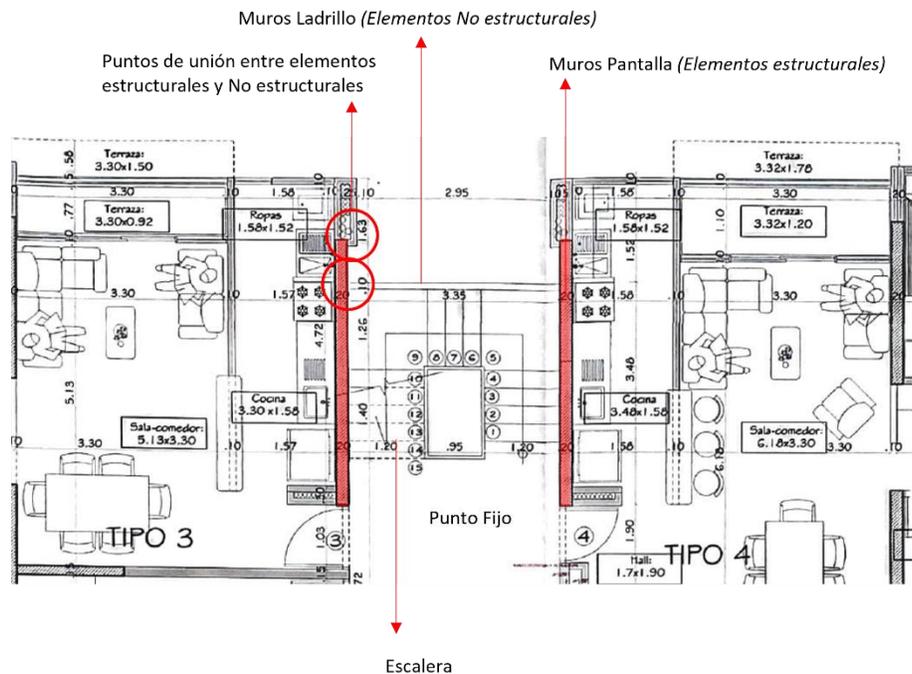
Detalle puntos fijos plano arquitectónico. Escalera - pasillo - acceso a los apartamentos 03, 04
